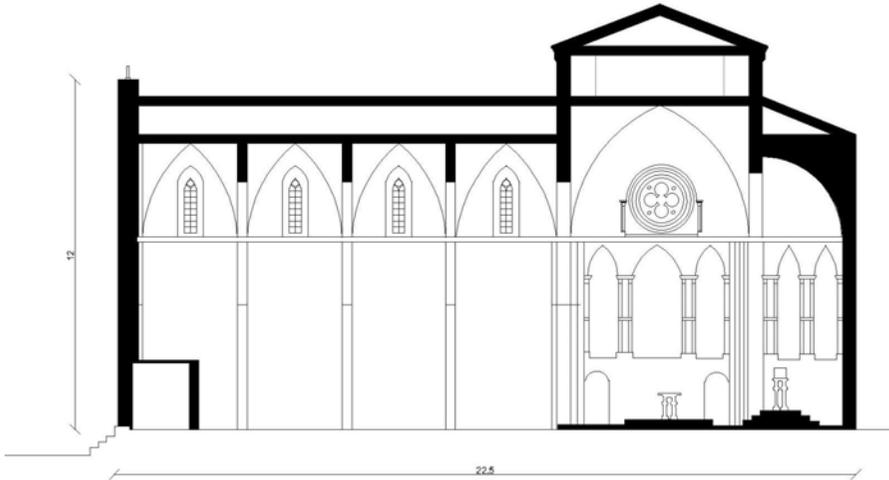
Sezione longitudinale Chiesa Santa Maria.
